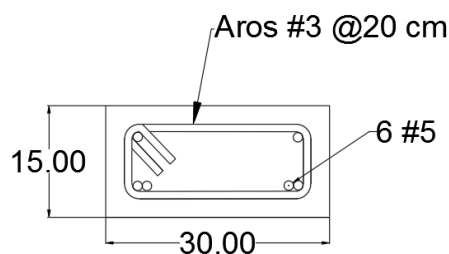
Detalle de columna en muros RA1.5 y RA2.
